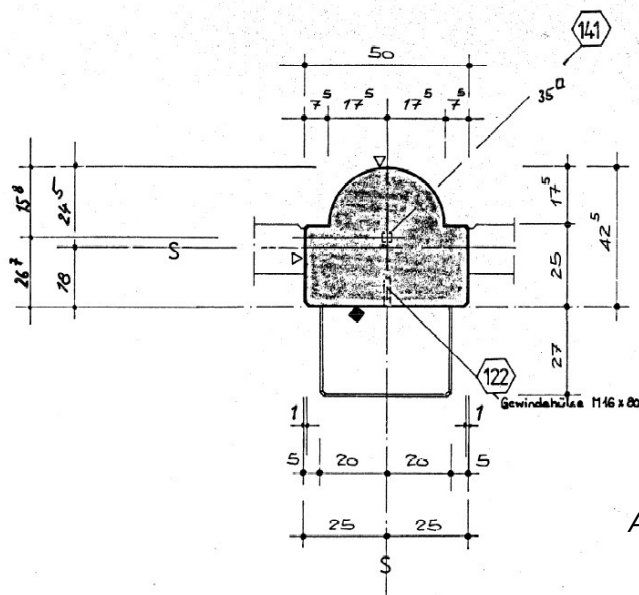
Querschnitt einer Fassadenstütze
